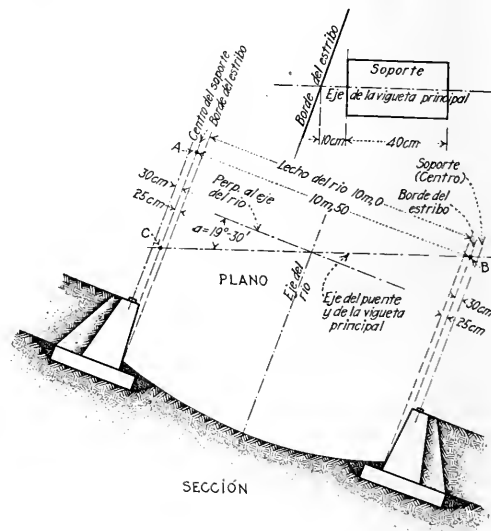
SECCIÓN PARA EL CÁLCULO DEL PUENTE
